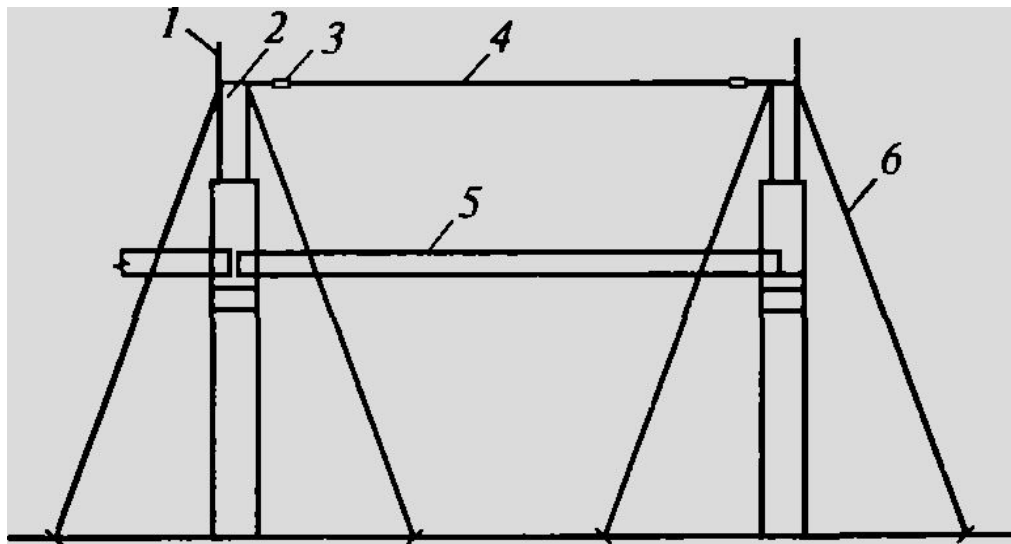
Установка и раскрепление первых двух стропильных ферм:
